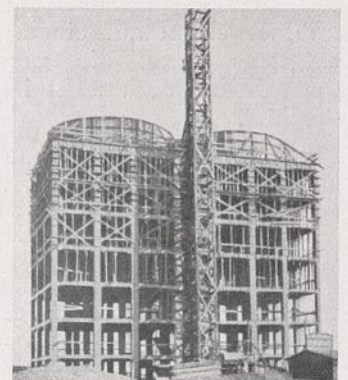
u. 7. Wesermünde, Wohnwasserturm. Ausführung und Eisenbetonrohbau.
